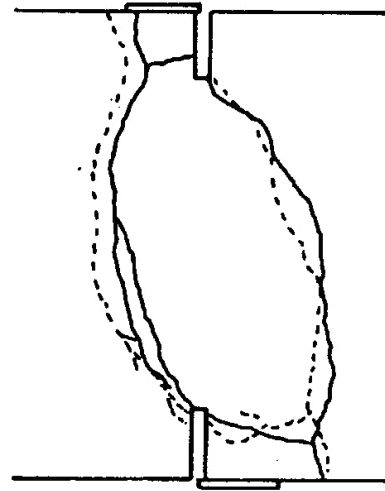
Faciès de fissuration obtenu en fin de chargement pour la poutre doublement entaillée d'après (Schlangen, 1993).
